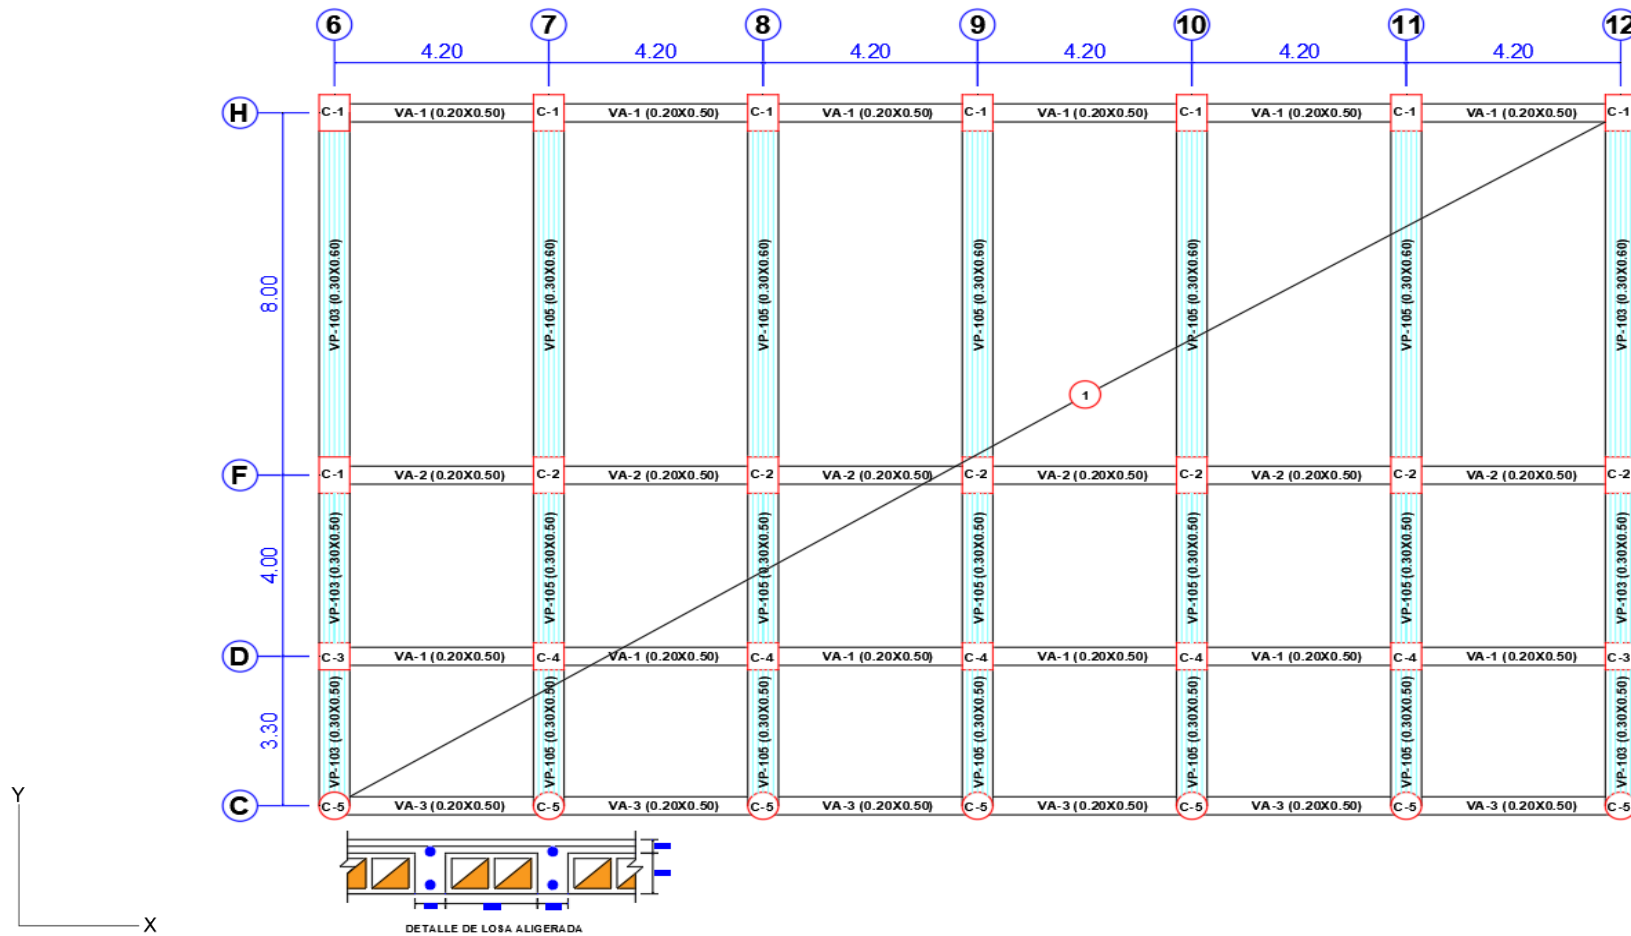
Distribución de los elementos estructurales del Primer Nivel (Fuente: Archivos del Área de Archivo Central, de las obras ejecutadas en la Universidad Nacional de San Martín – Tarapoto)
